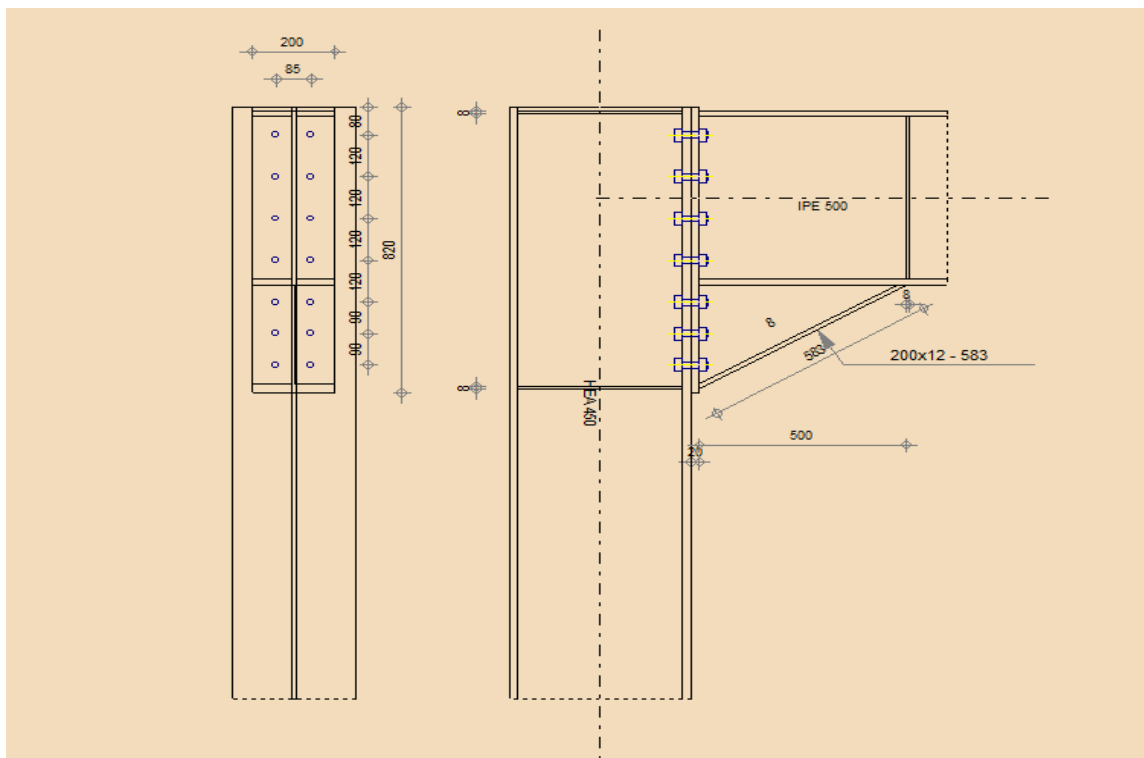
Détail d'assemblage poteau - poutre principale.
